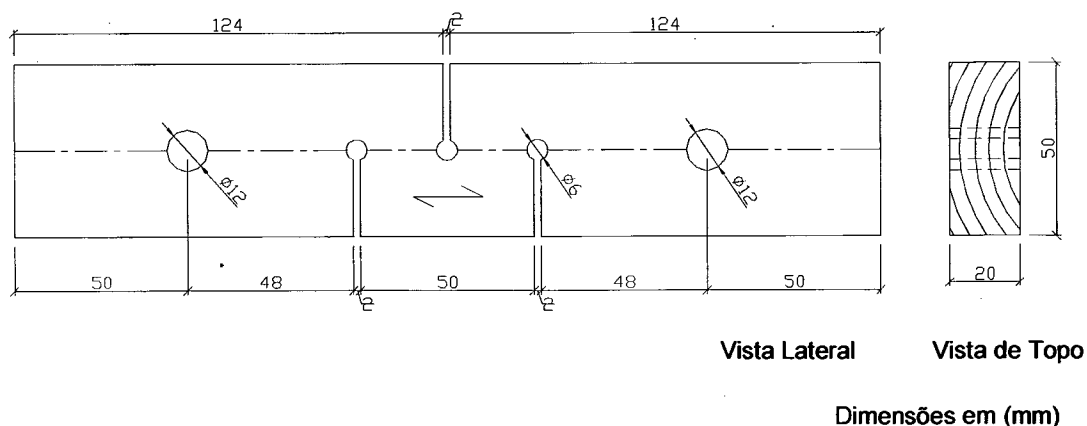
Corpo-de-prova estudado modificado para o ensaio de cisalhamento paralelo às fibras da madeira.
